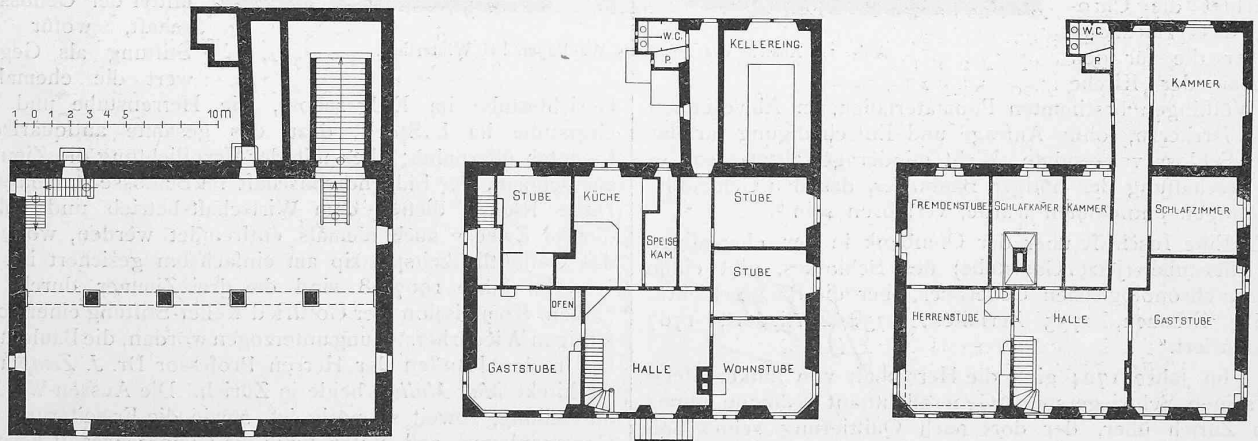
, 3 und 4. Grundrisse vom Keller, Erdgeschoss und ersten Obergeschoss des Schlosses Wülflingen. — Masstab 1 : 400.
